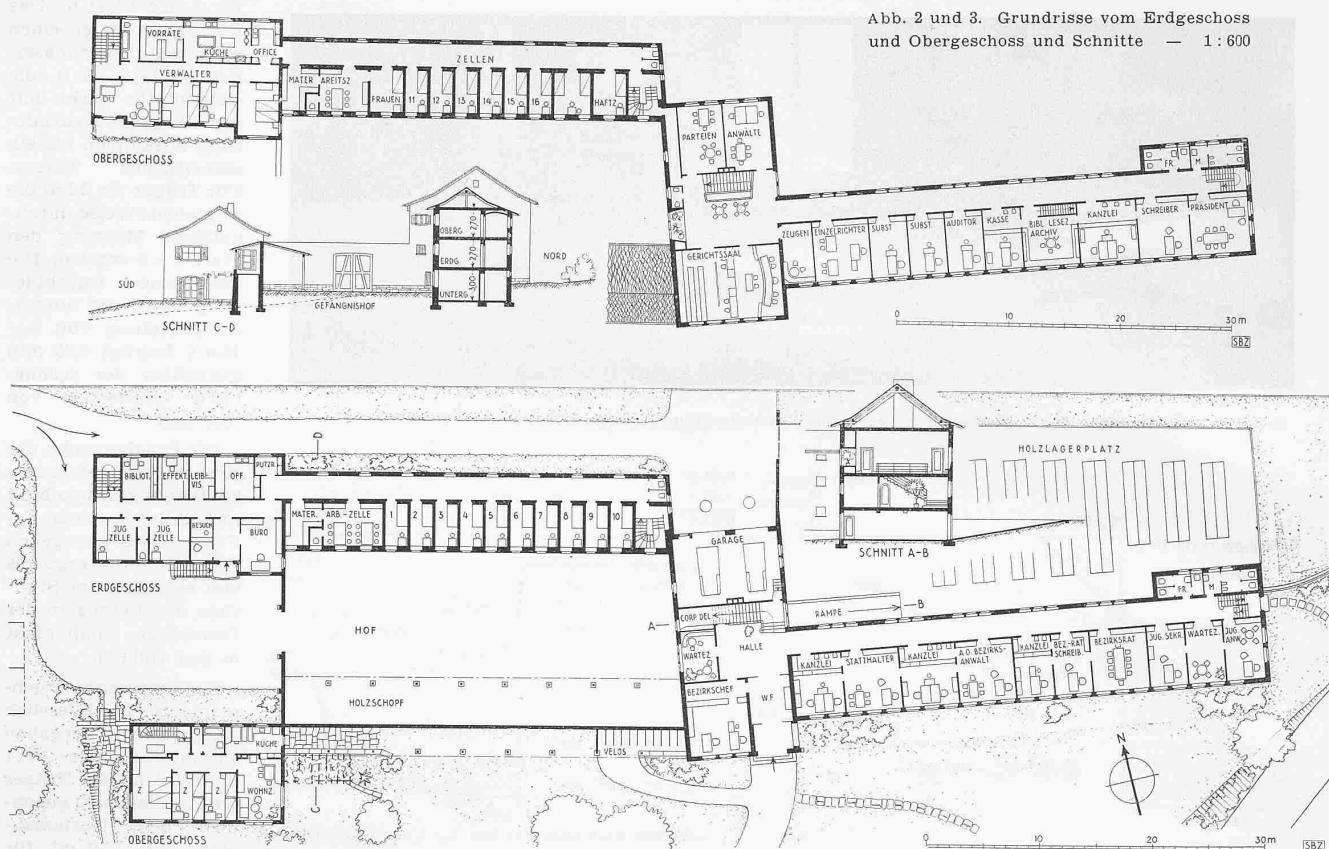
und 3. Grundrisse vom Erdgeschoss und Obergeschoß und Schnitte — 1:600
